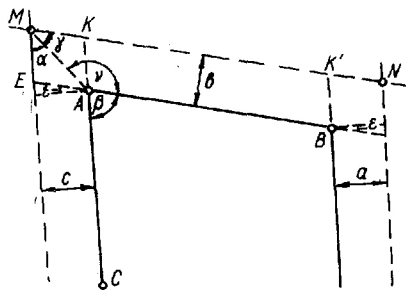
Схема расположения красных линий и трубопроводов под произвольным углом.
